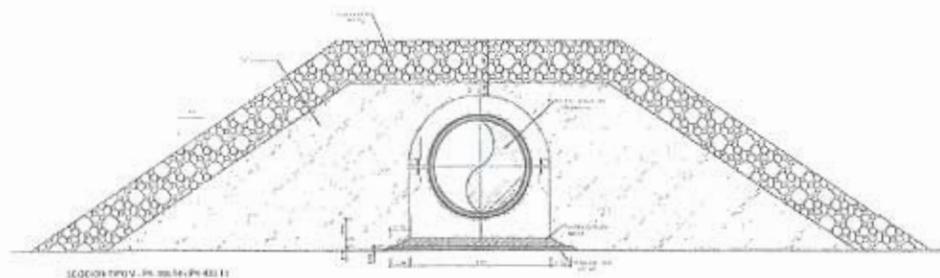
Sección tipo en el tramo donde el recubrimiento sobre la clave de la tubería es inferior a un metro. Sección tipo playa
